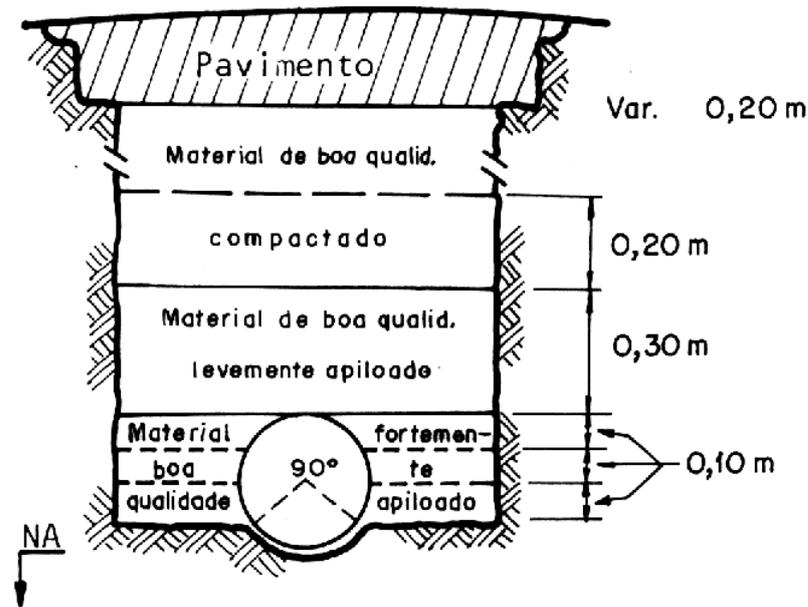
Detalhe da espessura das camadas de compactação para tubo assentado em apoio direto (NBR 9814, 1987)
